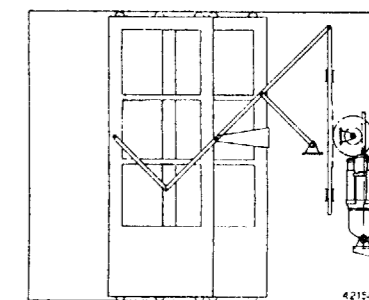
El gato electro-hidráulico abre y cierra sin ruido.
